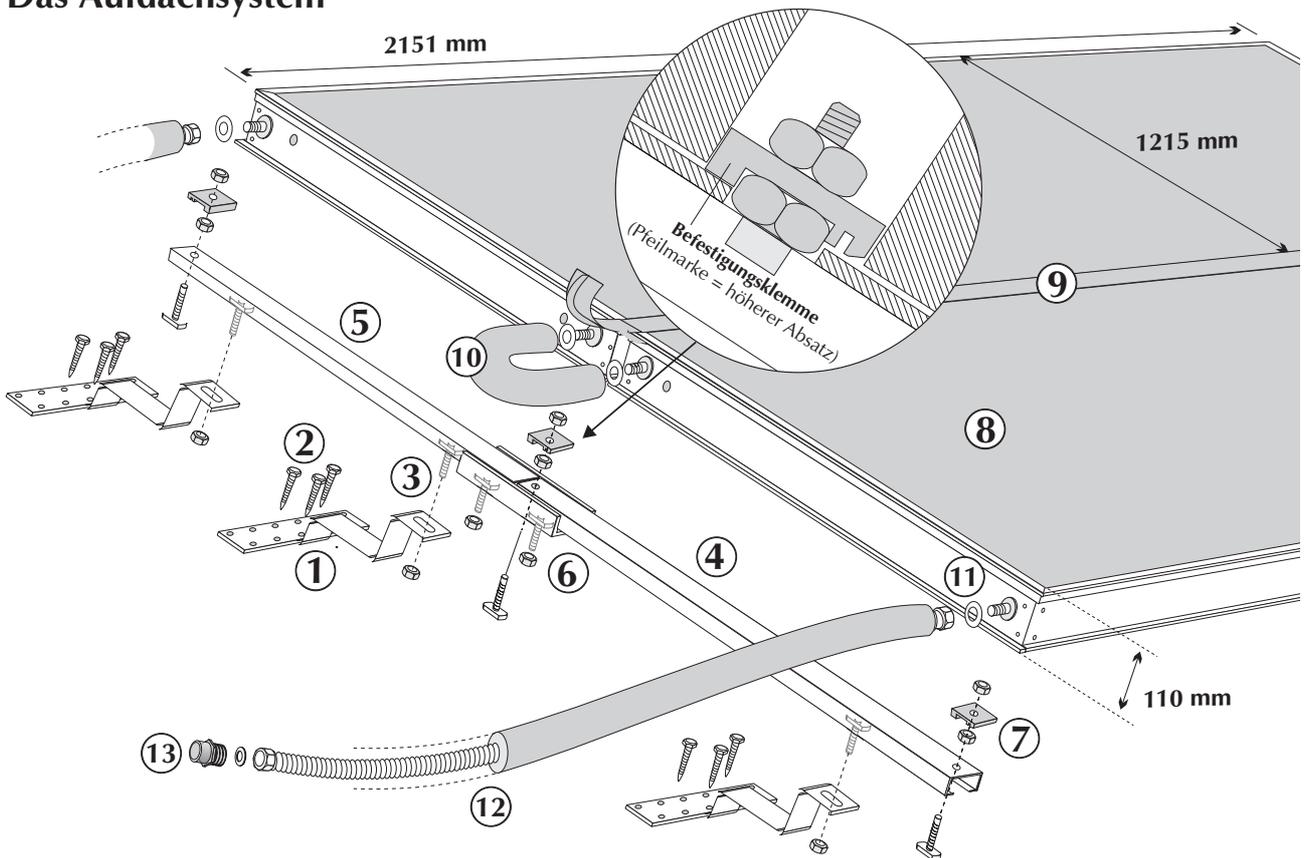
Grundset rapidosolar-Kollektor-Aufdachmontage für waagrechte oder senkrechte Kollektoranordnung (hier am Beispiel der waagrechten Kollektoranordnung): 1 Sparrenanker, 2 Schnellbau-Schrauben 6x80, 3 Hammerkopfschraube aus Edelstahl M10x30 mit Mutter, 4 Grund-Montageschiene 1257 mm lang, 5 Erweiterungs-Montageschiene 1223 mm lang, 6 Kupplungsstück mit Hammerkopfschrauben aus Edelstahl M10x30 mit Mutter, 7 Befestigungsklemme mit Hammerkopfschraube aus Edelstahl M10x30 und zwei Muttern, 8 rapidosolar-Kollektor (nicht Bestandteil des Grundsets), 9 Abdeck-T-Profil aus Silikon, 10 Edelstahlwellschlauch mit Überwurfmuttern 1/2" und Isolierung 20x13 mm, 235 mm lang, 11 Dichtungsring, 12 Edelstahlwellschlauch mit Überwurfmuttern 1/2" und Isolierung 20x13 mm, 900 mm lang, 13 Löt nipple 1/2 Zoll/18 mm.
